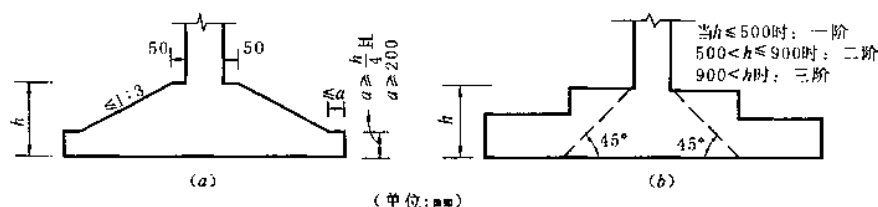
现浇钢筋混凝土柱基础剖面尺寸
